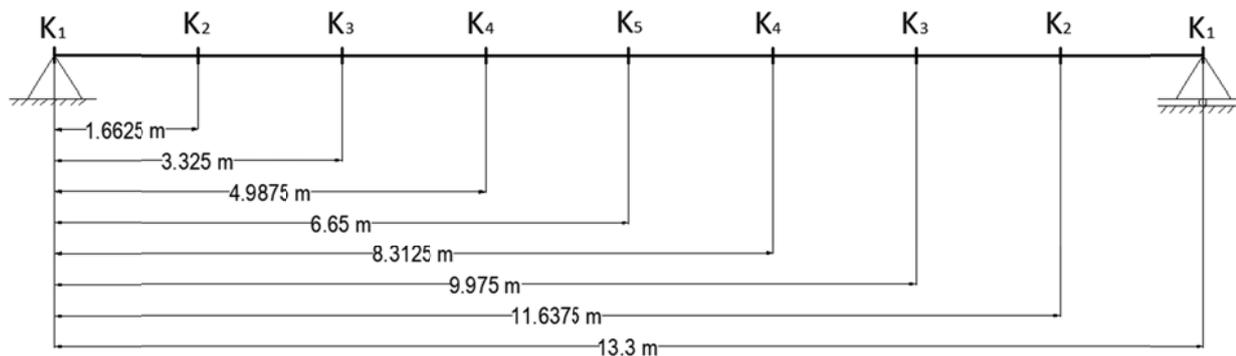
Seksionet ne te cilin do te ndërtohen vijat influente për traun me gjatësi 13.3 m
